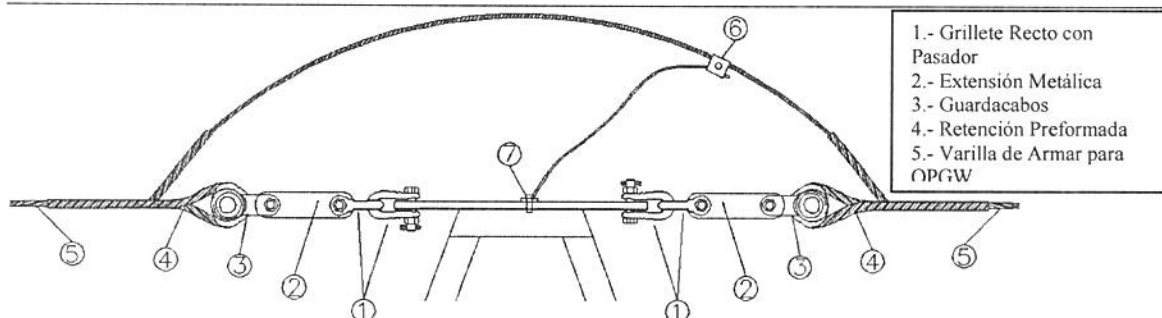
Referencia de conjunto de amarre pasante de OPGW para ser instalado en los 2 extremos de la torre
